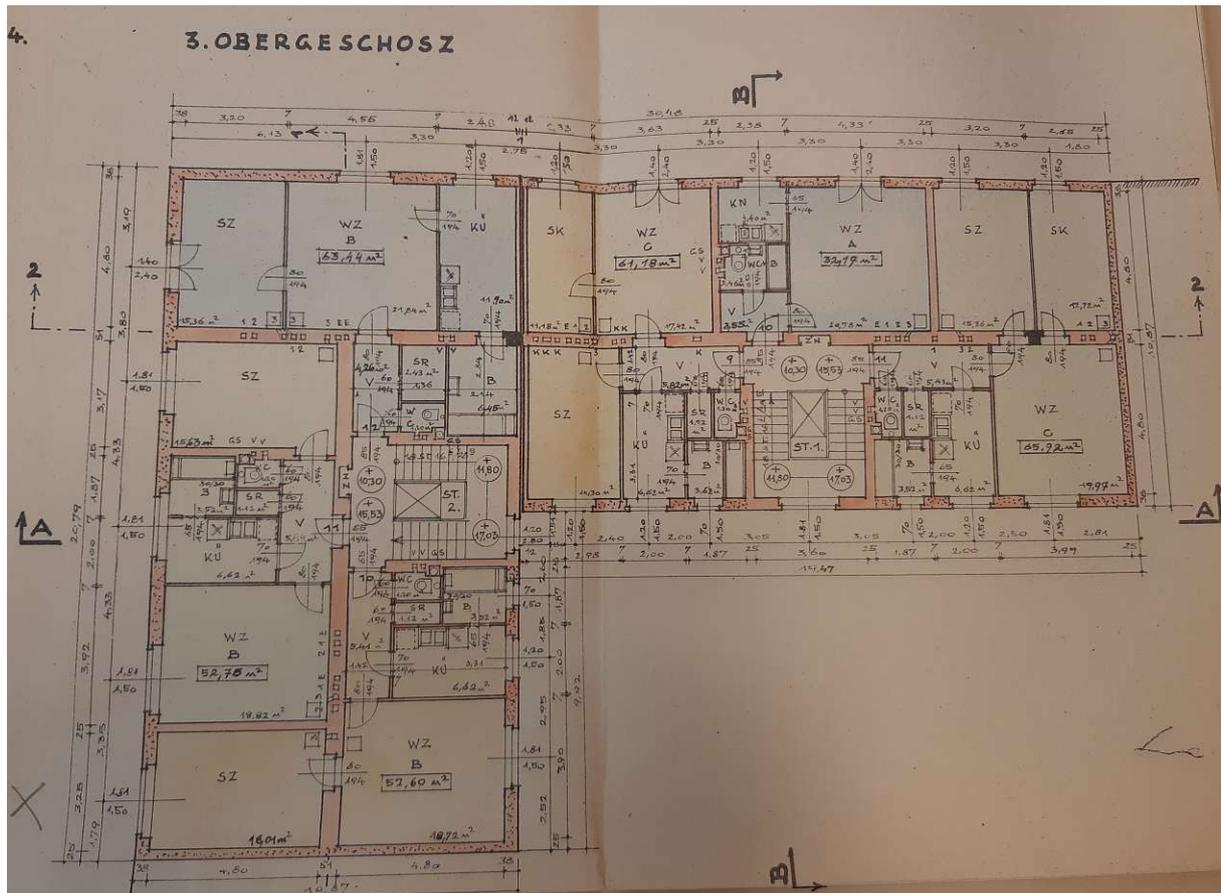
Darwingasse 12 - Grundriss 3.OG
